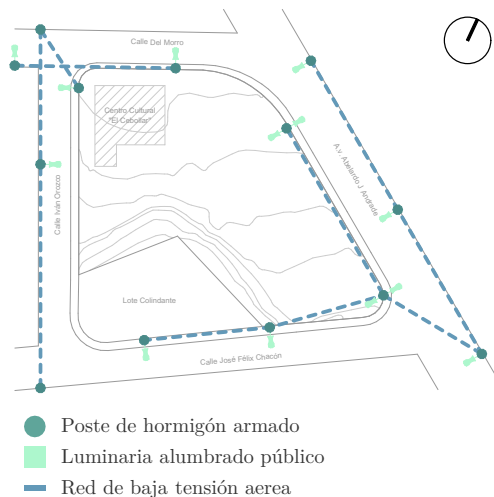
Planta Alumbrado Público. Fuente: Autores.
